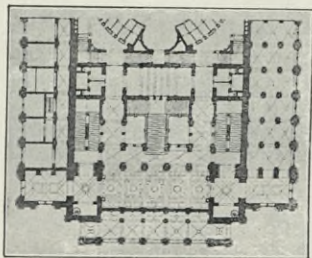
Hofopernhaus zu Wien. Grundriß des Vorderhauses.<sup>53)</sup>
